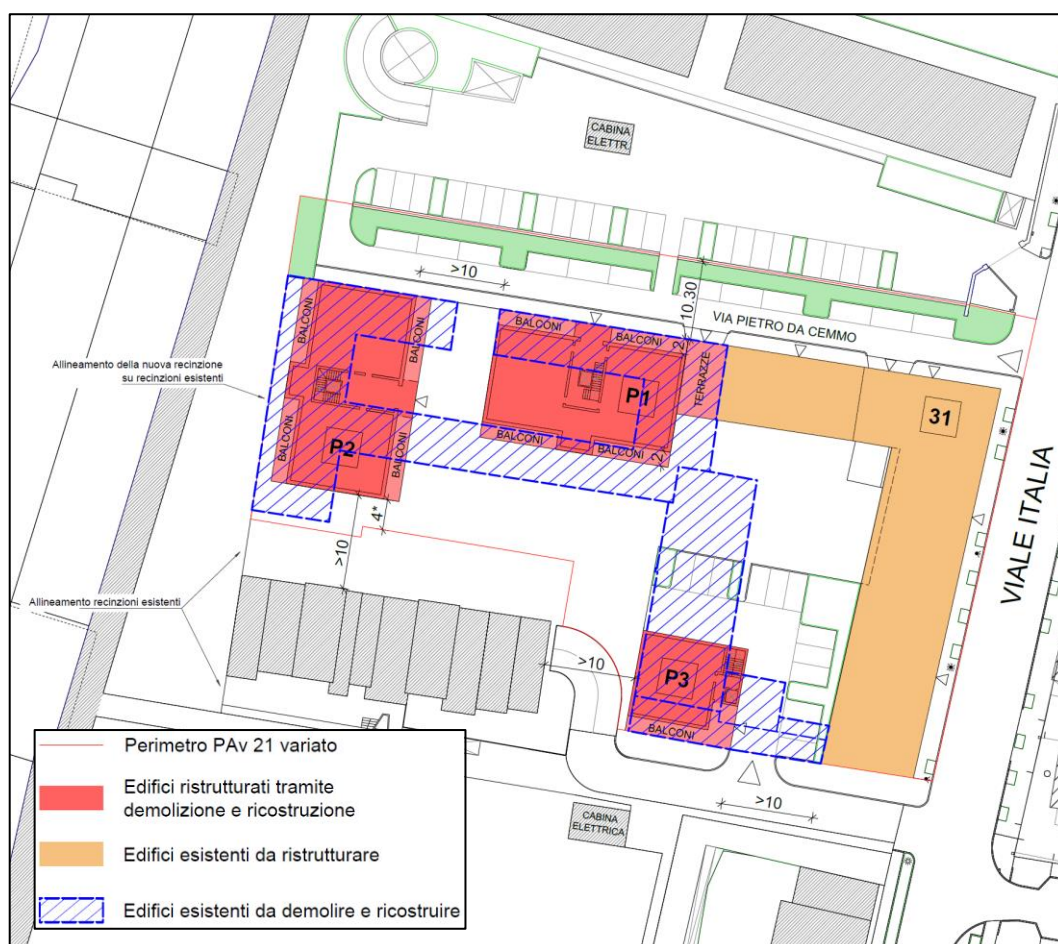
Perimetro del Piano Attuativo ed interventi previsti
